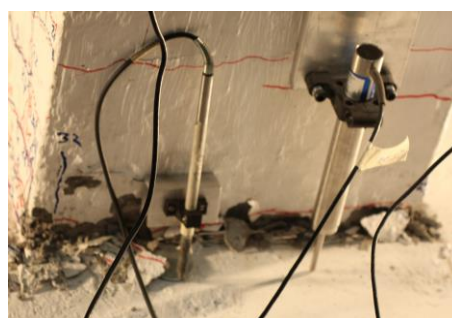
Fissures verticales de compression sur la face latérale gauche de la colonne C1A au LS32
